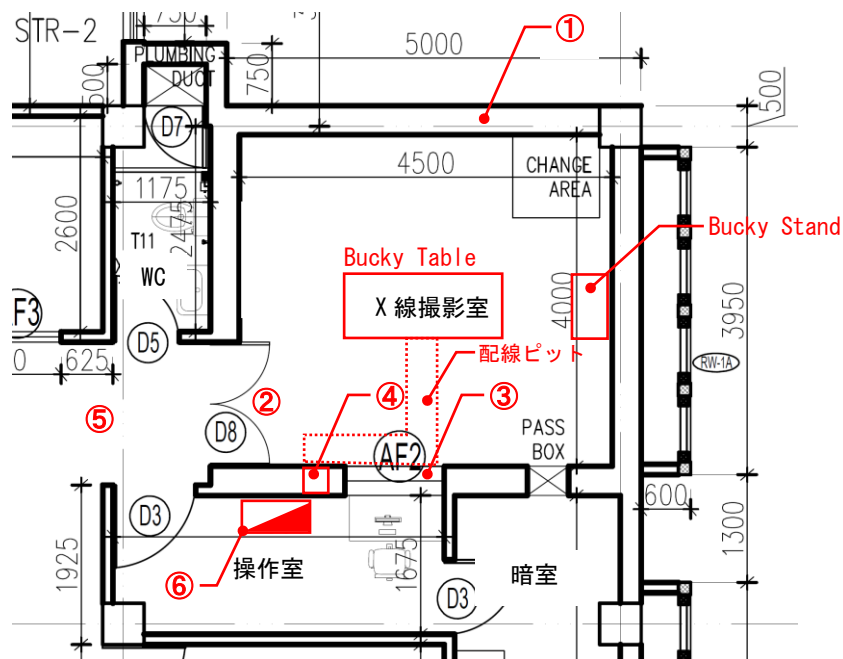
BLOCK-2 1 階平面図 (東部地域母子保健病院)
